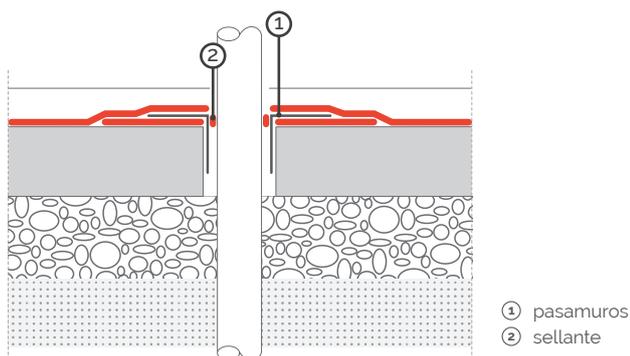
Encuentro de la barrera tipo lámina con un elemento pasante vertical mediante un pasamuros
